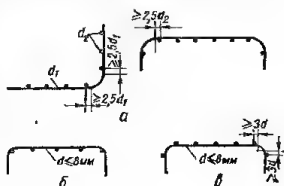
Сварные сетки с гнутыми стержнями одного направления:
